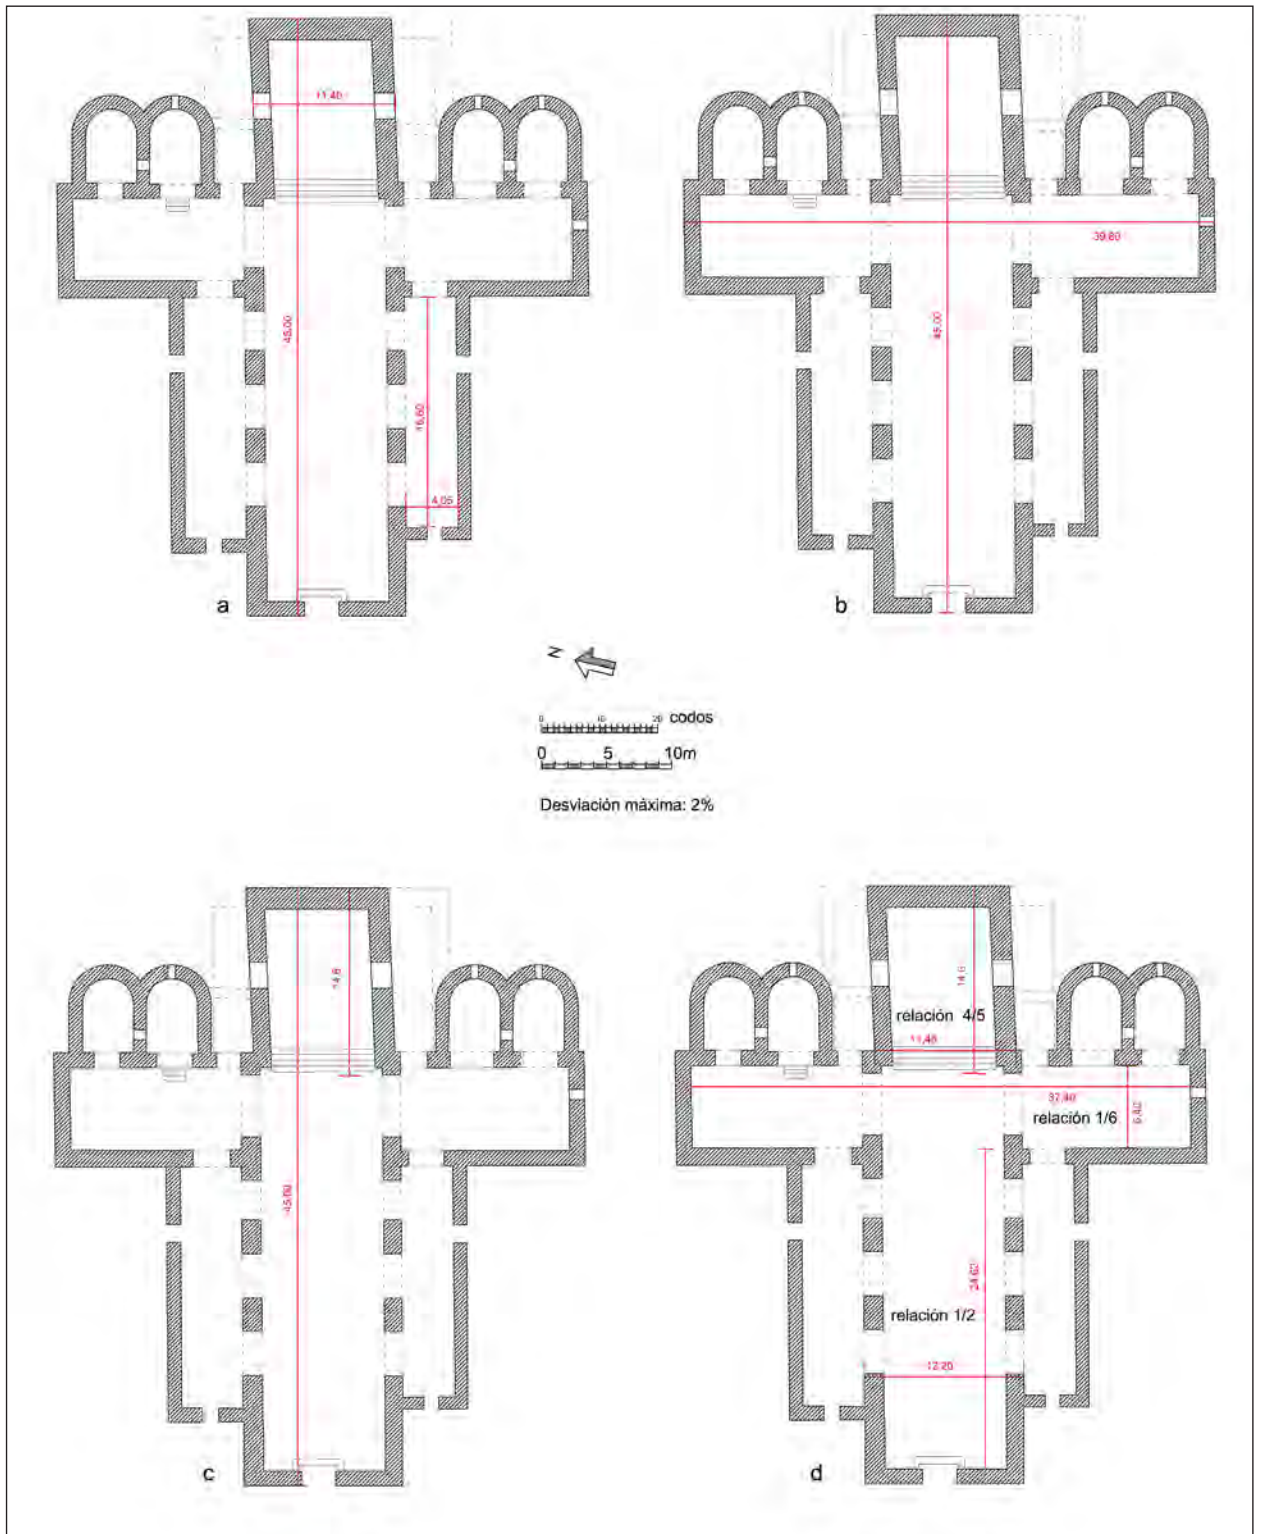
Planta de la fase del siglo X. Relaciones proporcionales. 13a: 1/4; 13b: 7/8; 13c: 1/3; 13d: 4/5, 1/6 y 1/2 (planimetría de la autora).
